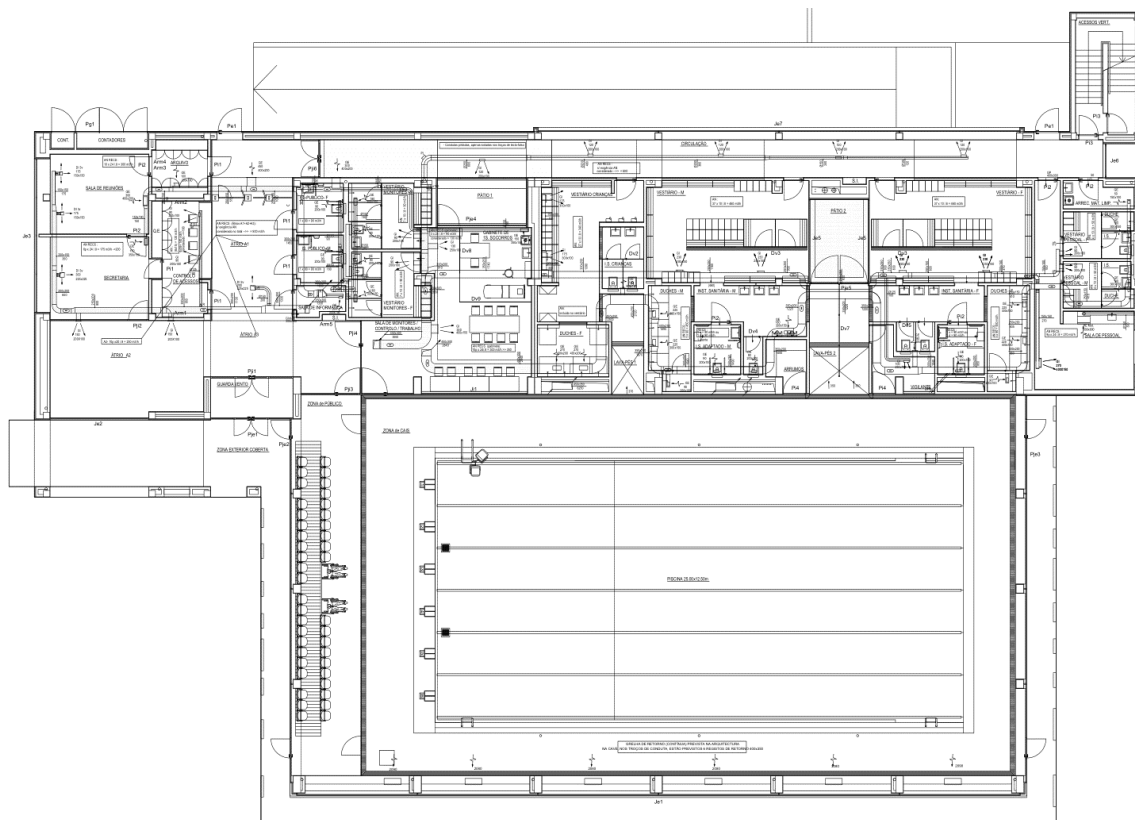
Planta do Piso 0 do edifício da Piscina Municipal.
